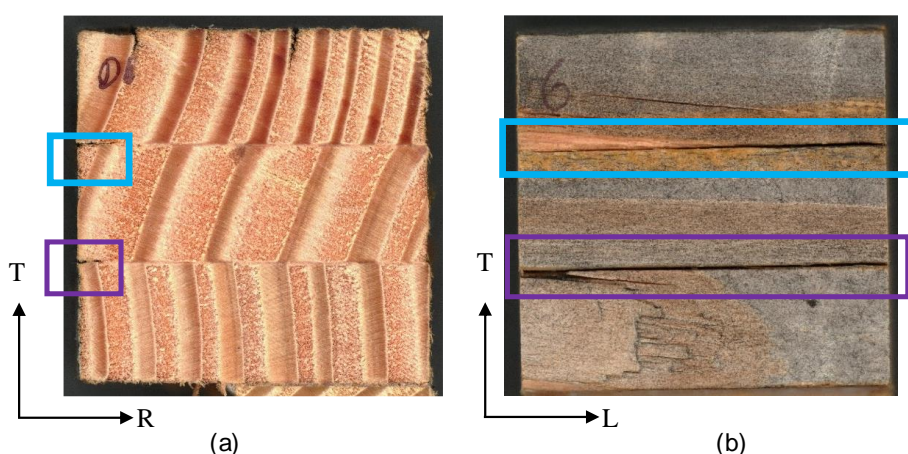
Délaminations sur des échantillons d'une éprouvette après 1 an d'exposition en extérieur sans chargement : (a) : plan TR ; (b) : plan TL
